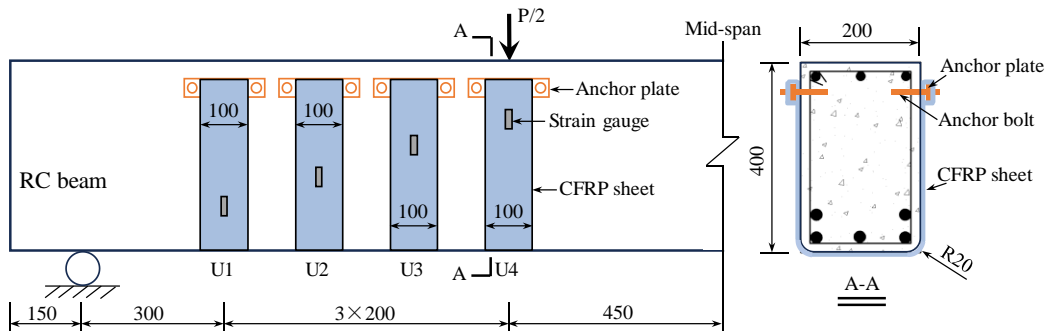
RC 梁的几何尺寸及配筋示意图 (单位: mm)
